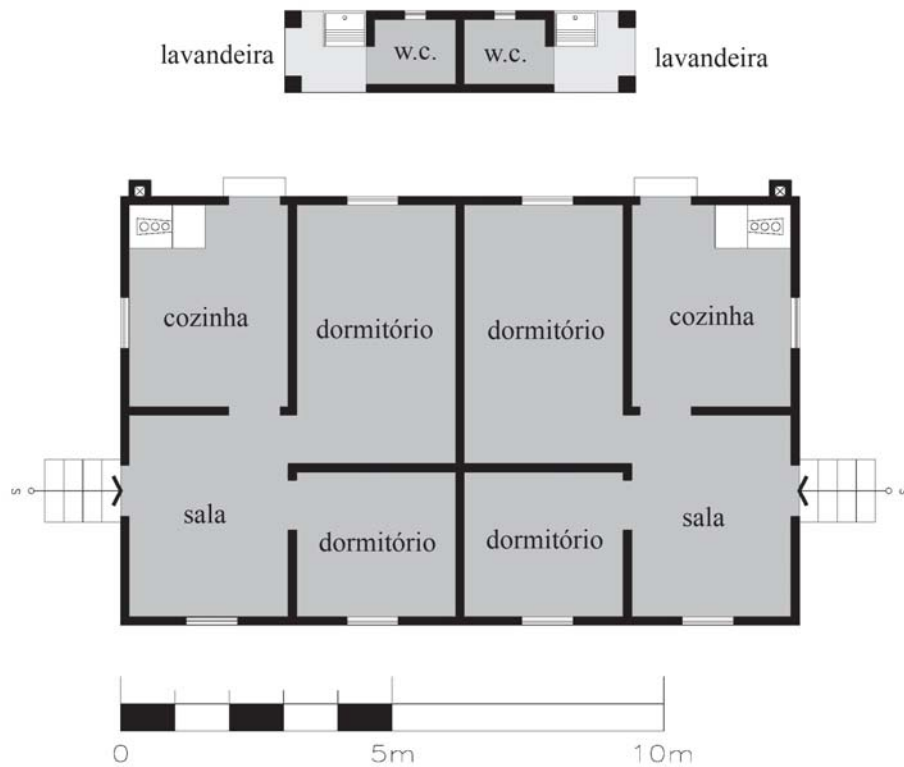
(topo) - Planta de casas geminadas, da colônia denominada Tamoio, fazenda Igrê, Garça. Essas casas dispõem de uma lavanderia e um banheiro, em edificação isolada, no quintal. Foto: V. Benincasa.
